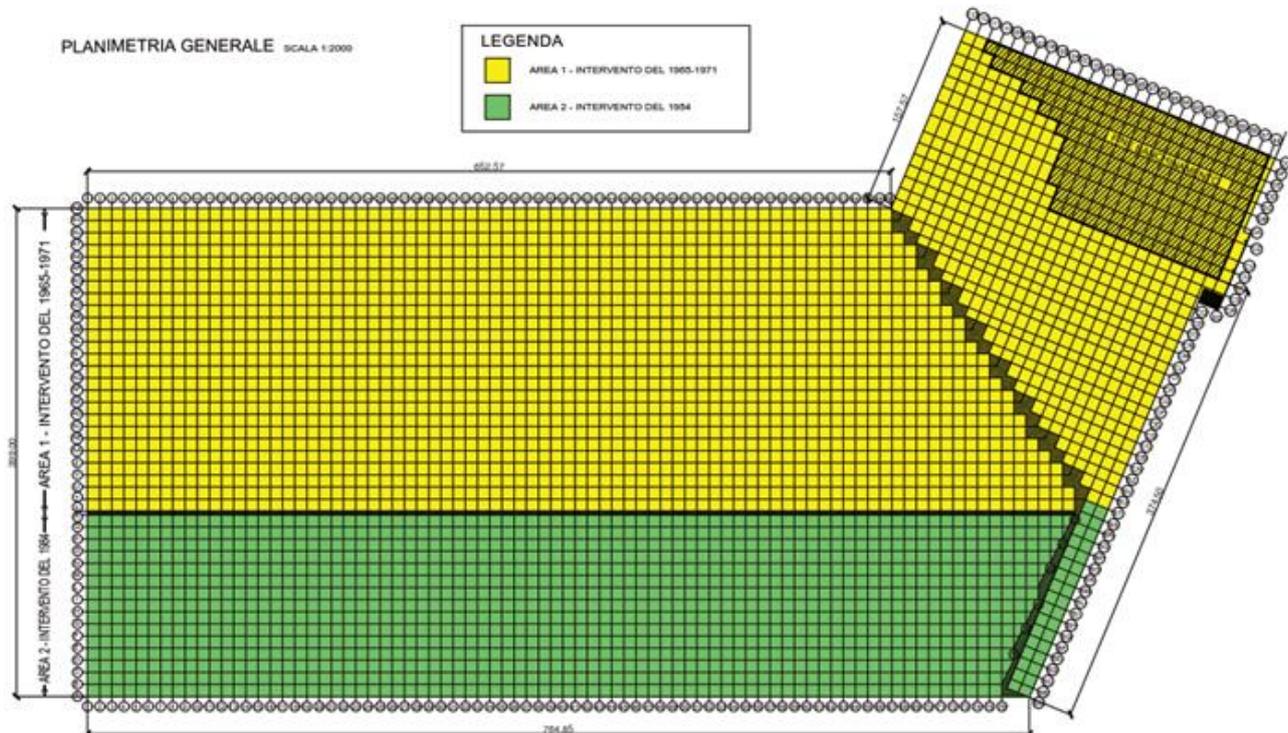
planimetria delle piastre prefabbricate con indicazione del periodo di realizzazione
